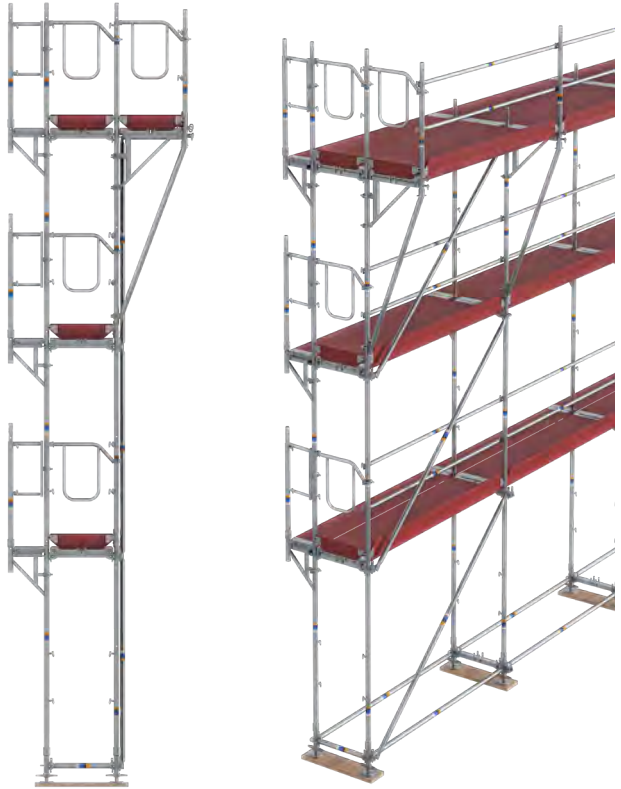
2-bohlige Verbreiterungskonsole außen mit Abfangstreben (Abfangstrebe nur im Dachfanggerüst erforderlich)
